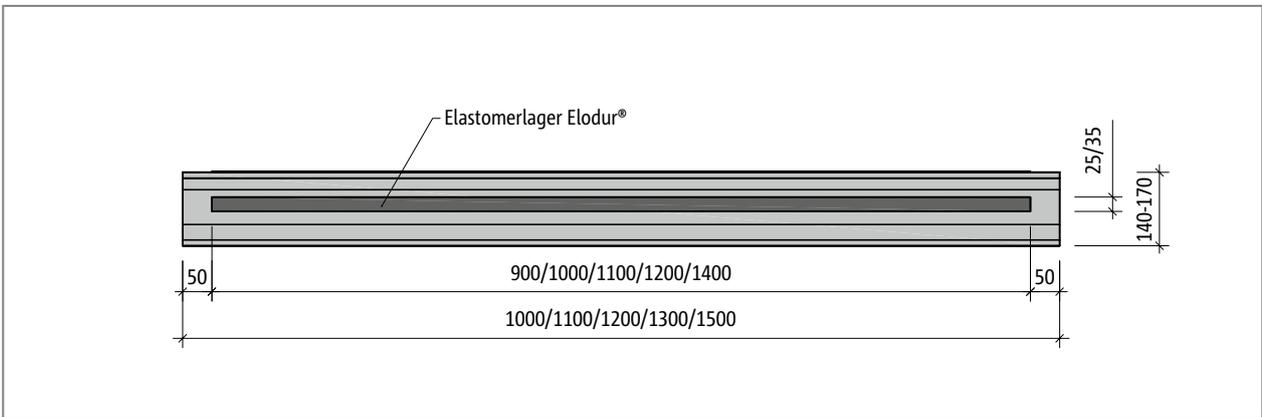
Schöck Tronsole® Typ F: Grundriss
